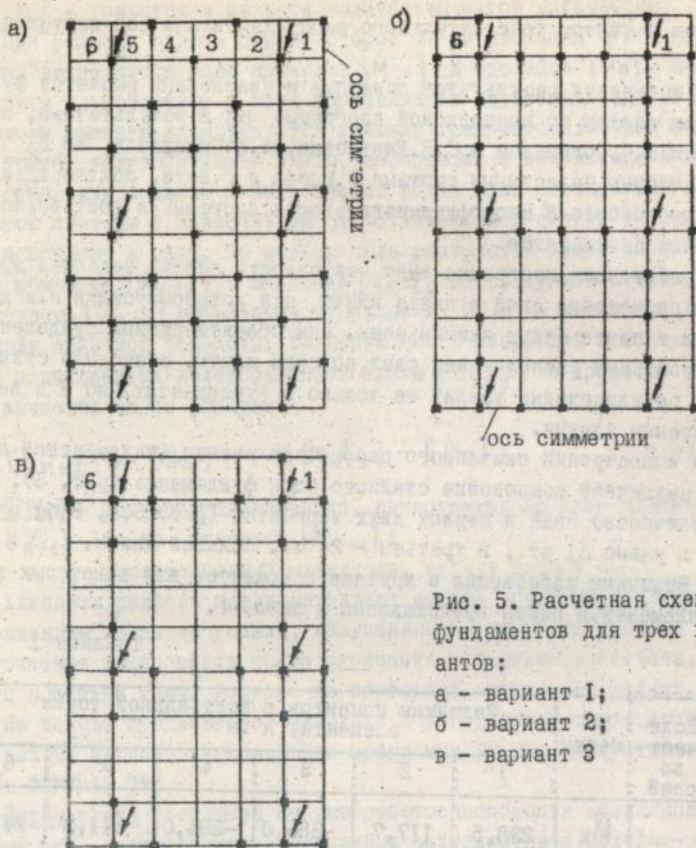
Расчетная схема фундаментов для трех вариантов:
